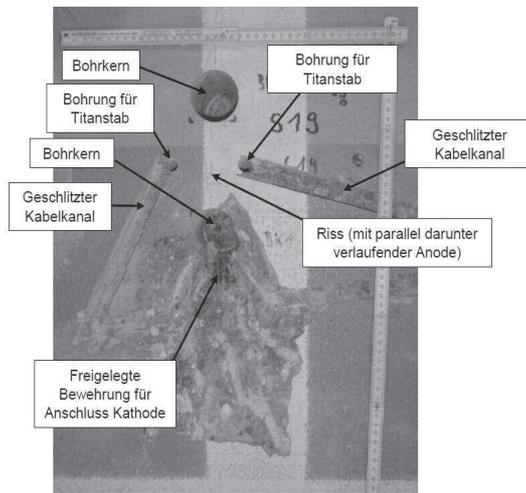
Installation eines Korrosionssensors im Rissbereich einer Tiefgaragendecke
